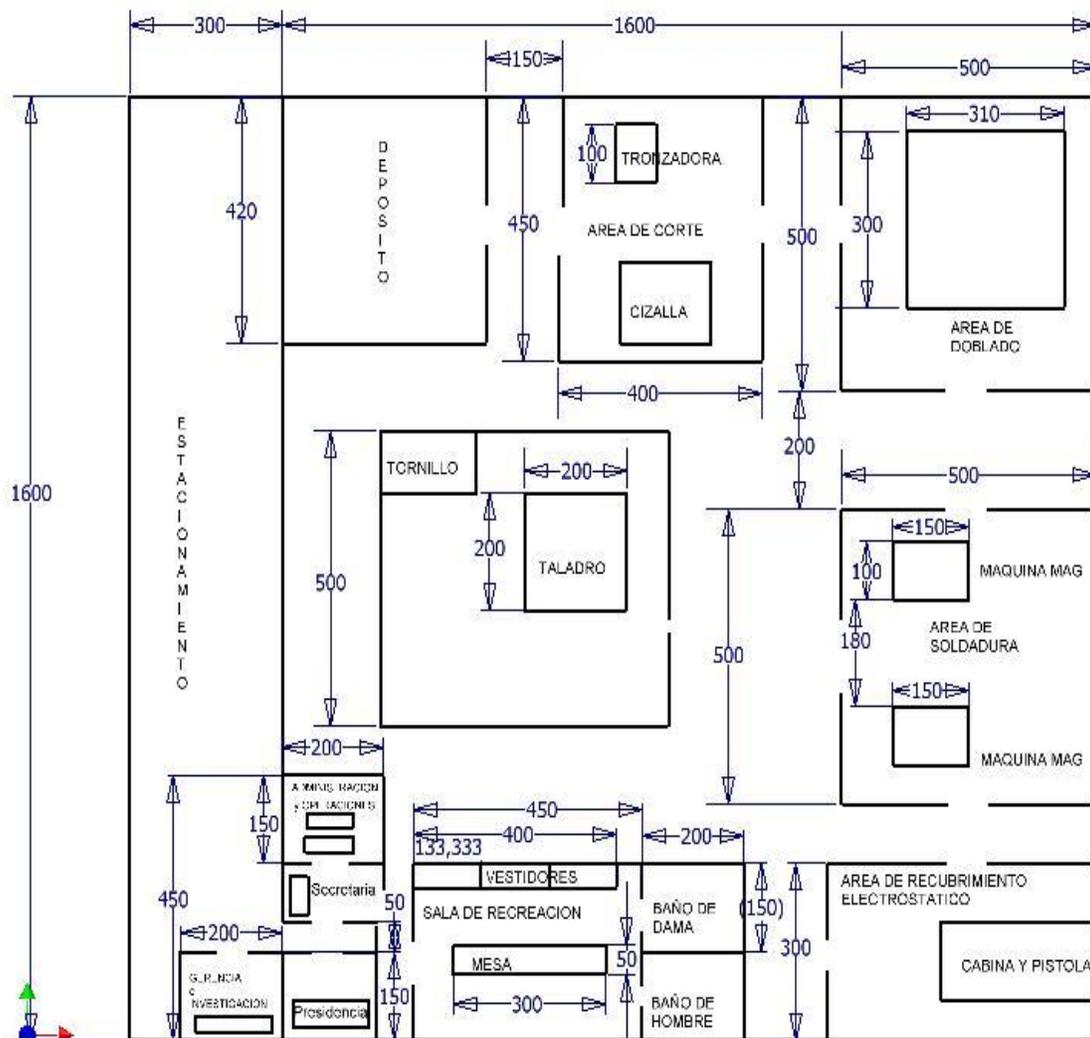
Vista del Plano de la Planta (medidas en cm)
